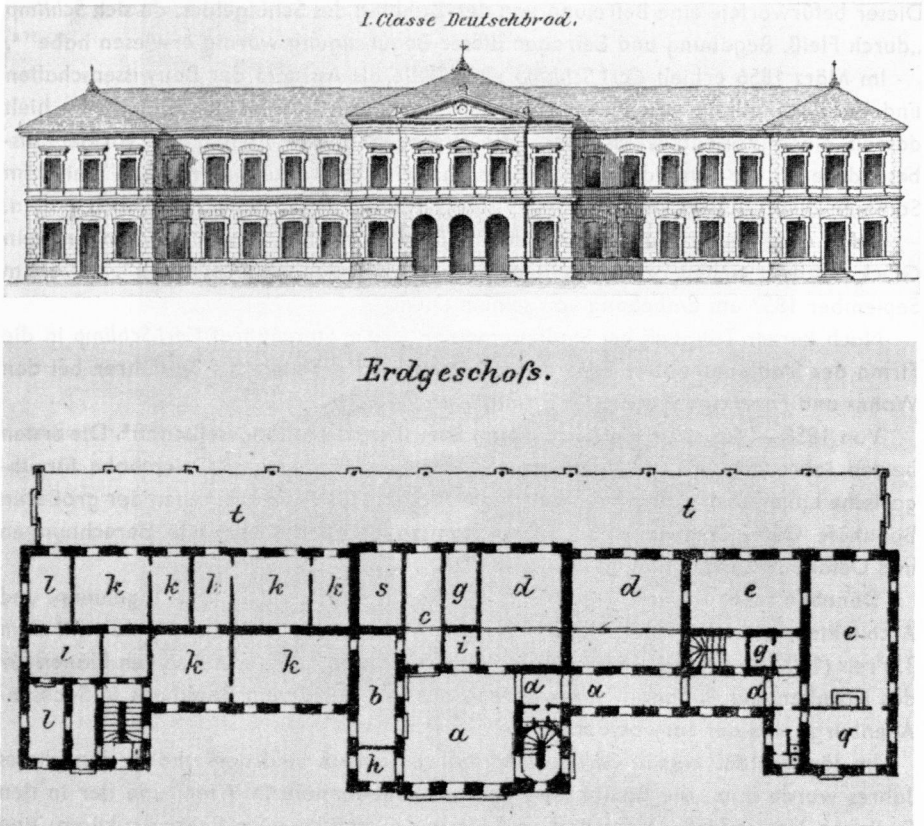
Der Bahnhof von Deutschbrod, Österreichische Nord-Westbahn, Fassade und Grundriß des Erdgeschosses, um 1870 erbaut
